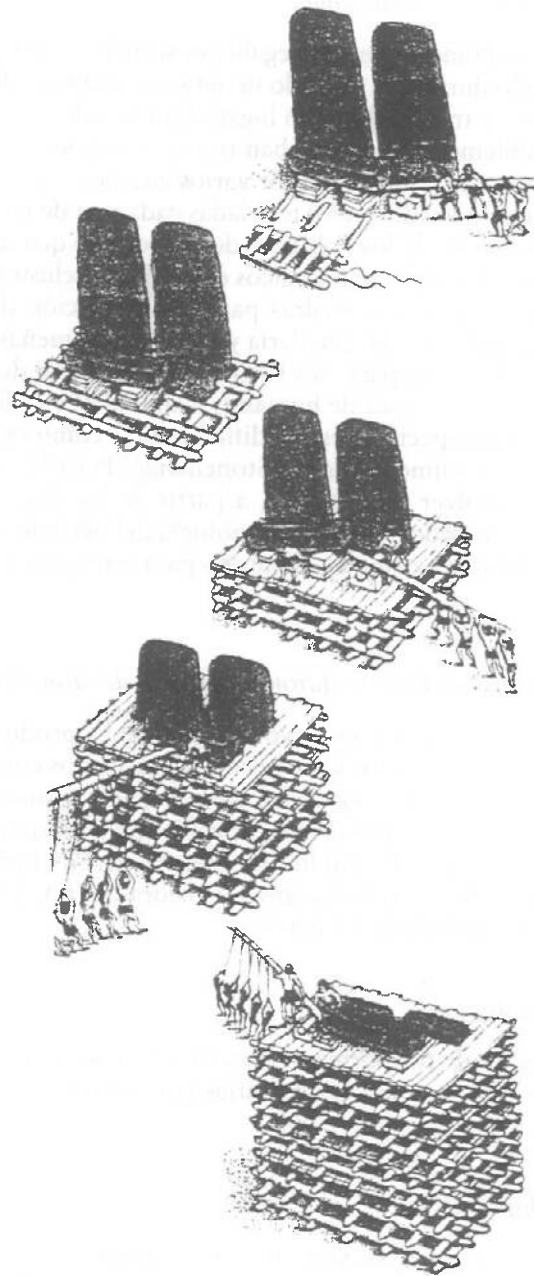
e Sistema de colocación de piedras dinteles
